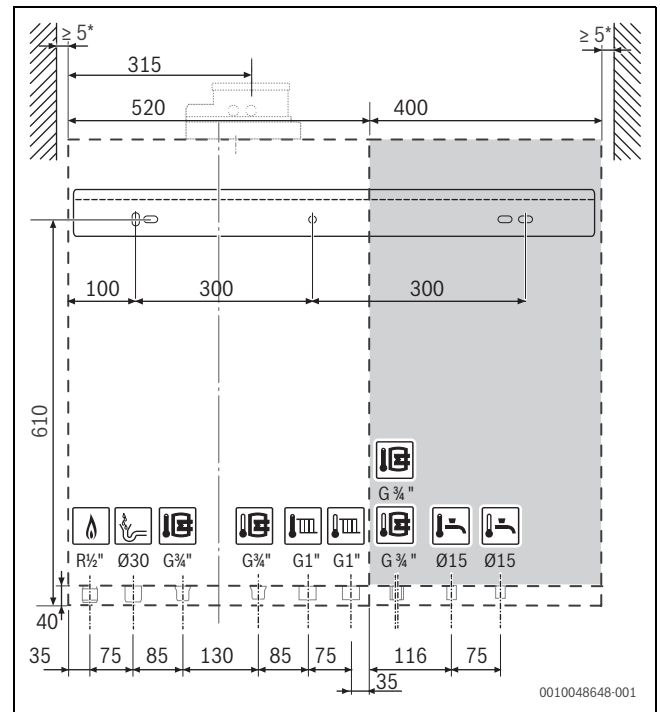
Frontansicht GB(H)192i.2-30 T40SW H (mm)
